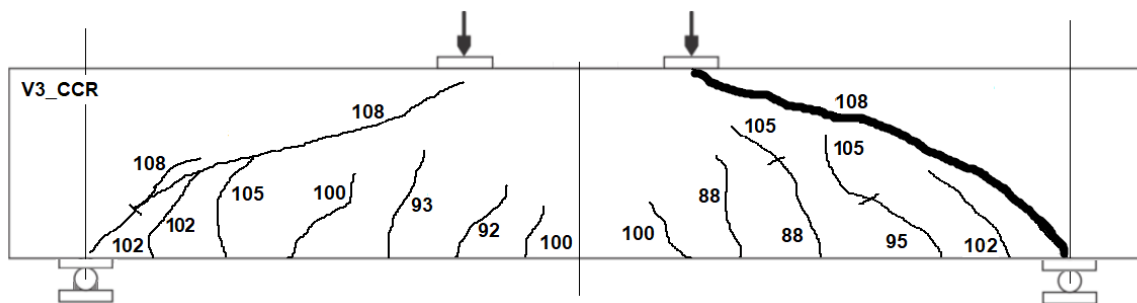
Esquema de fissuração da Viga 3_CCR.
